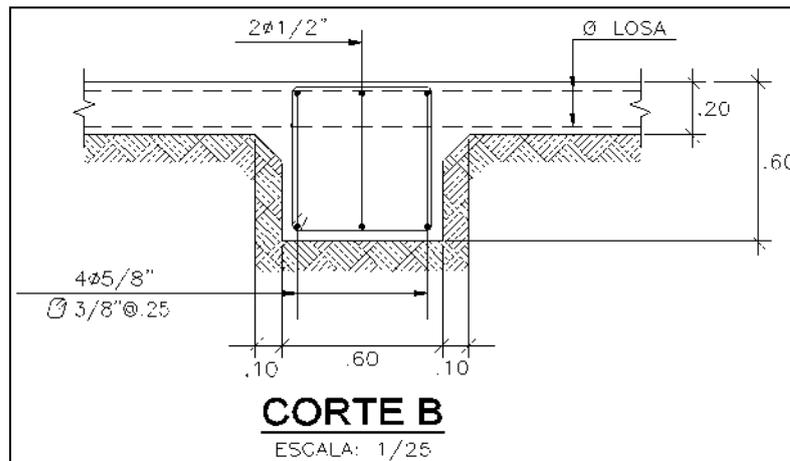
Viga de cimentación. FUENTE: Elaboración Propia
